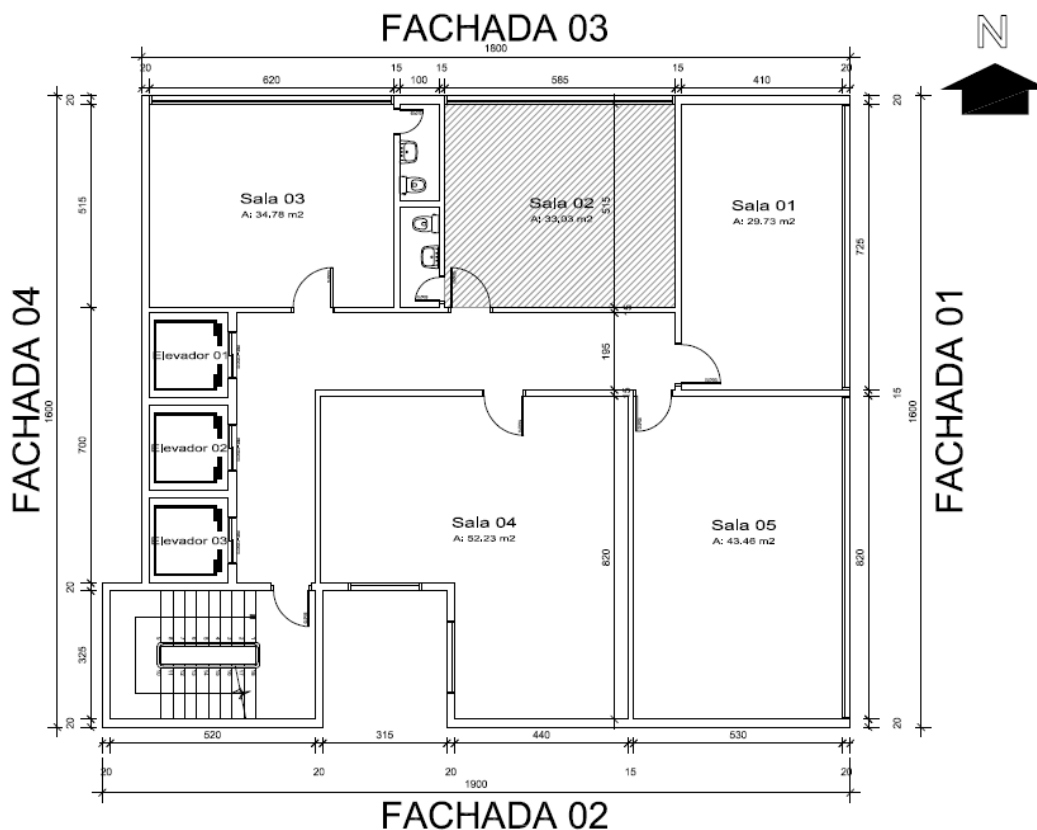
Planta baixa do pavimento tipo da edificação comercial escolhida
